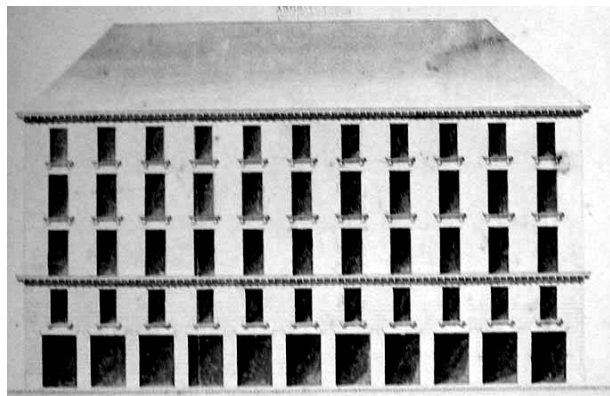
Façade bâtiment de la place Royale par Crucy en 1788 et extrait d'un module de façade
